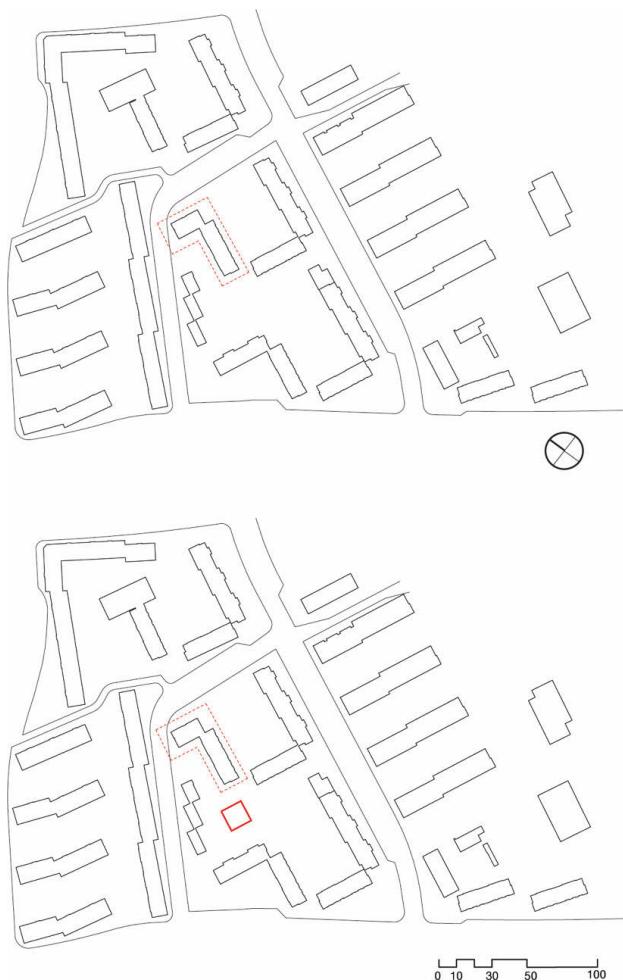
Lagepläne Nachverdichtung, Bremer Punkt 3
